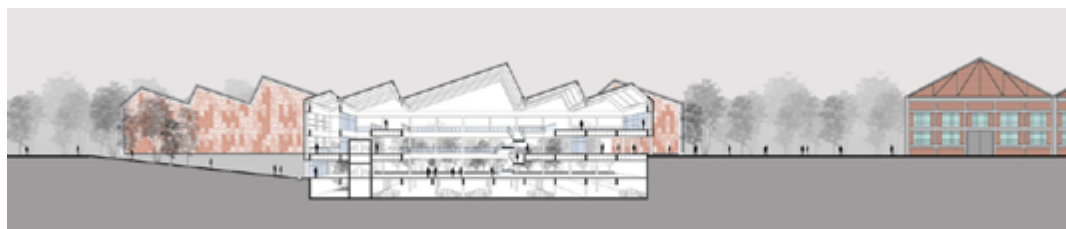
Corte longitudinal. Autoría: Elaboración propia
